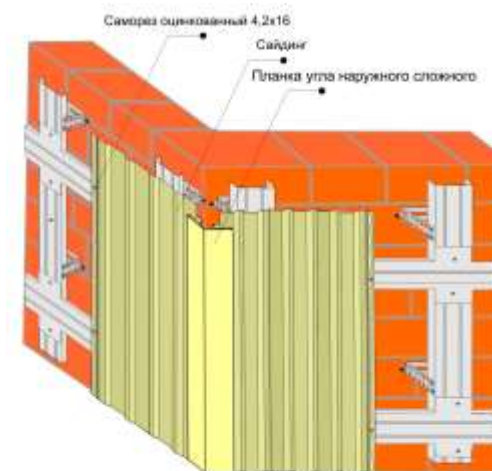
Использование наружного угла при вертикальном монтаже облицовочных панелей
